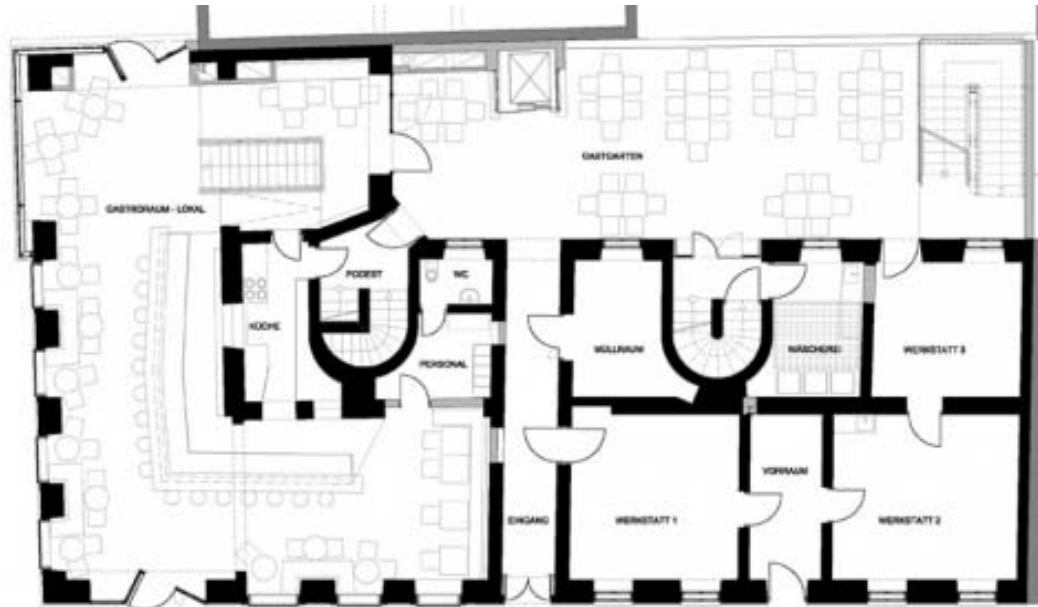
Grundriss EG »VinziRast-mittendrin«
